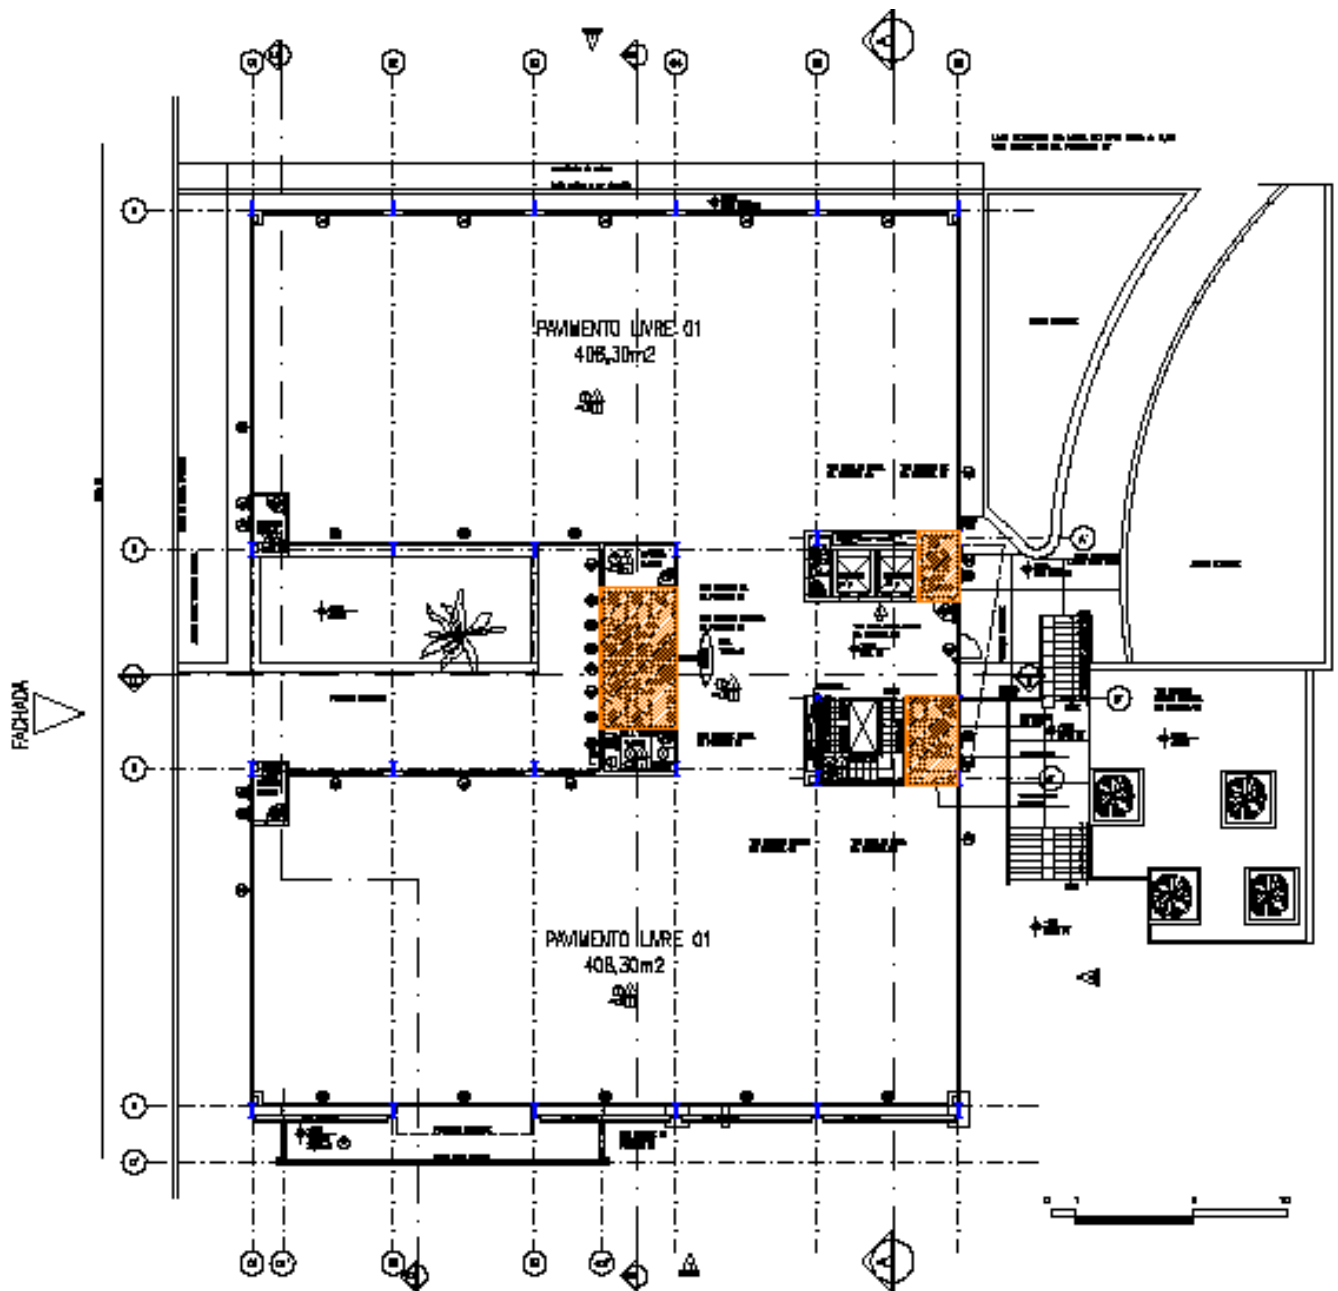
Projeto arquitetônico do empreendimento do estudo de caso – esboço do pavimento tipo (Fonte: adaptado projeto EC-A)²³
